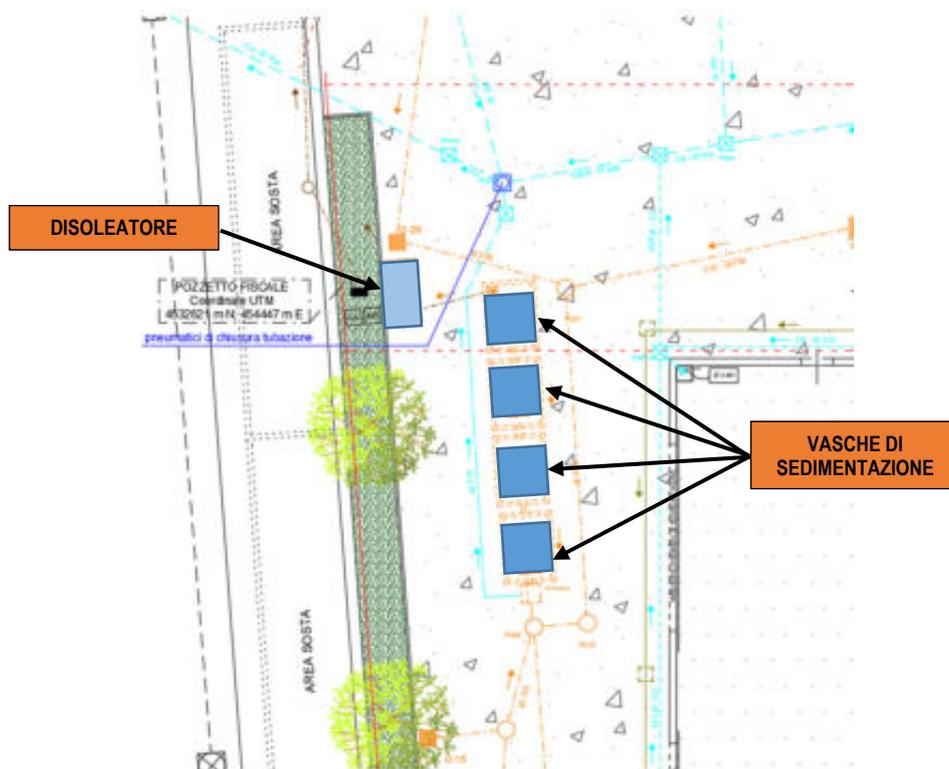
Stralcio planimetrico con individuazione delle sezioni costituenti l'impianto di trattamento acque di prima pioggia
